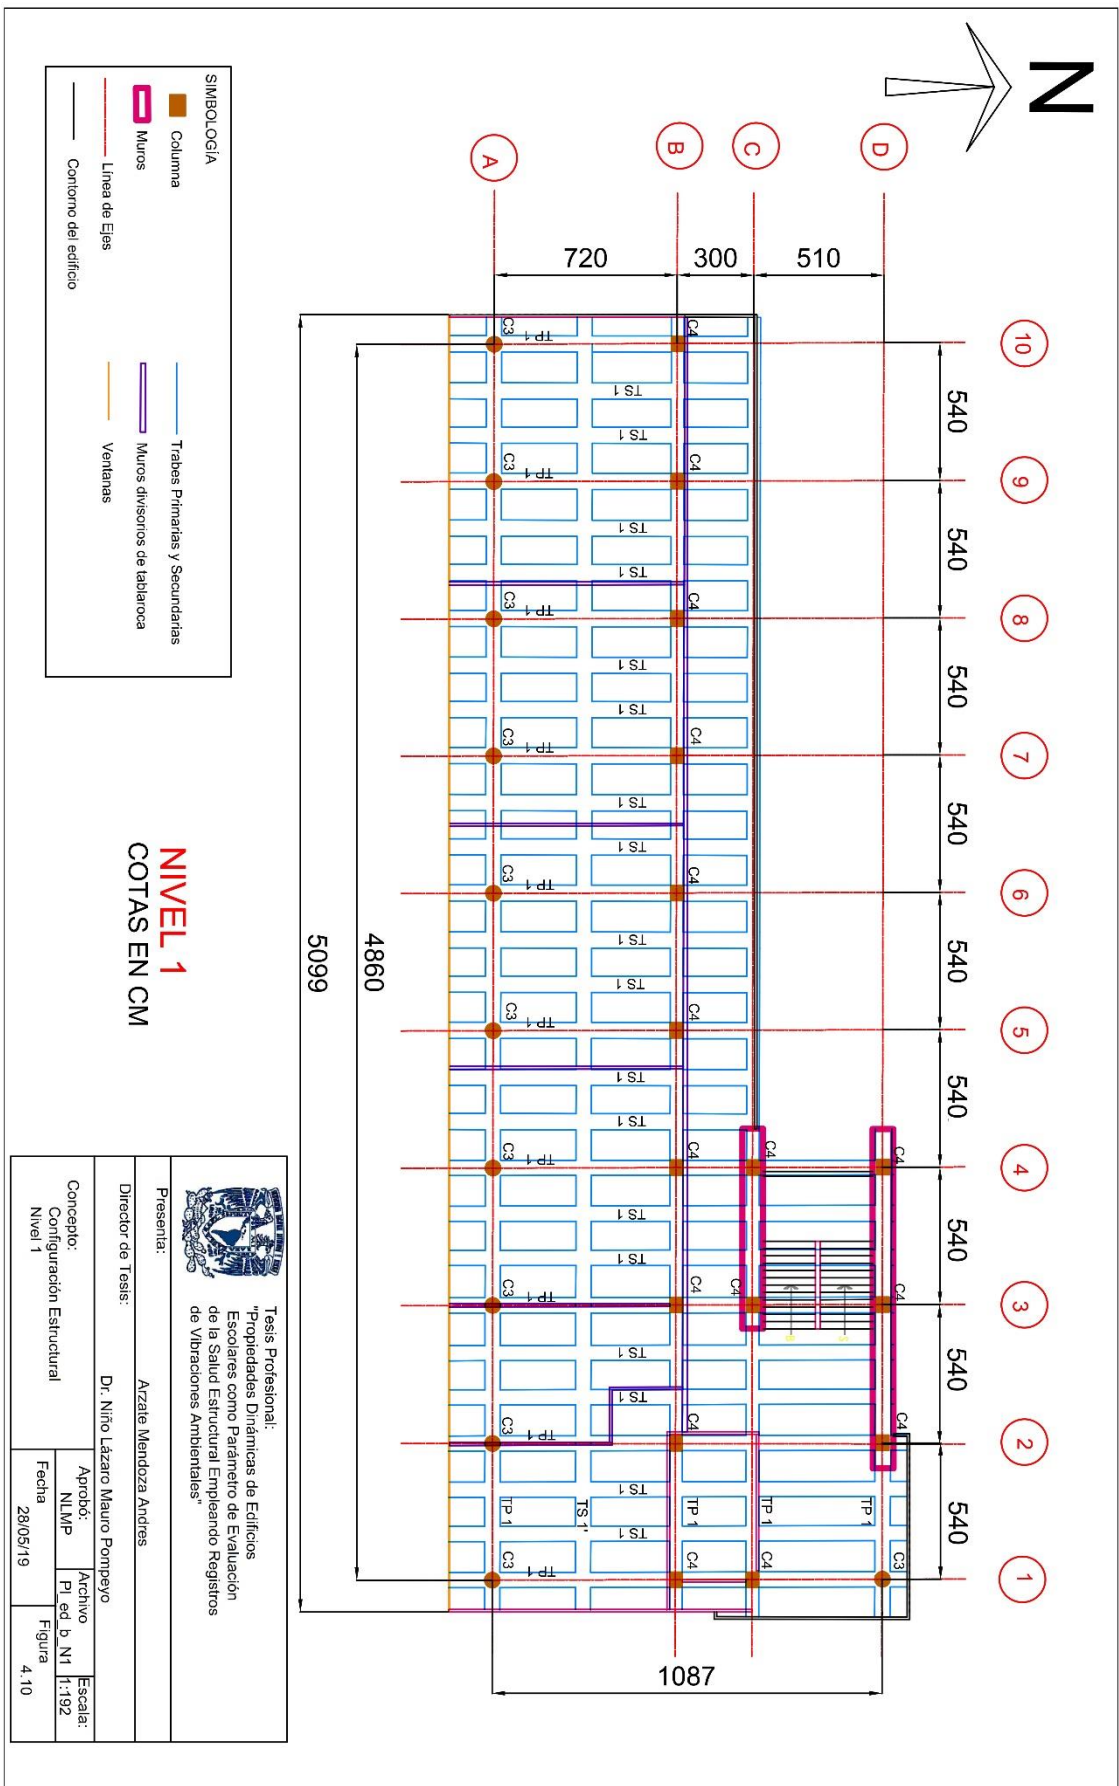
Planta estructural nivel 1 edificio B FI, UNAM
